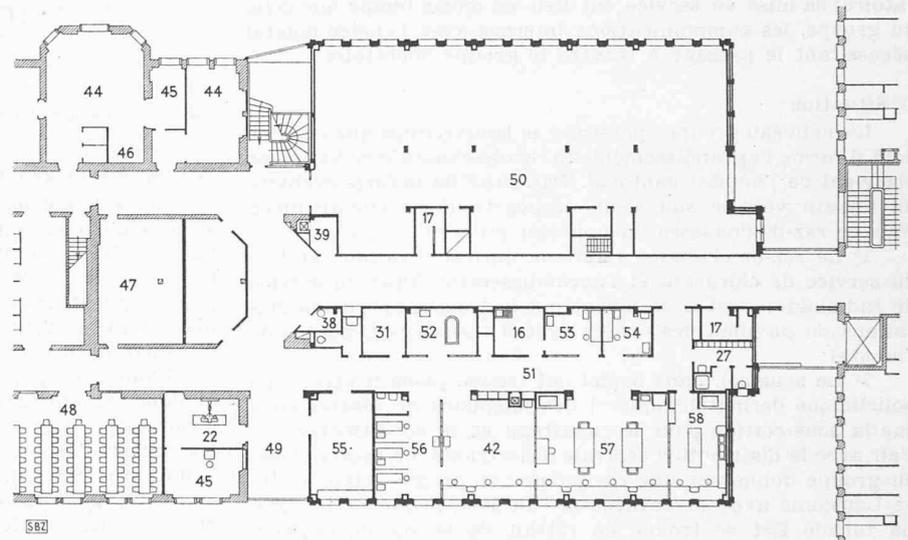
Plan du rez-de-chaussée inférieur, échelle 1 : 450
